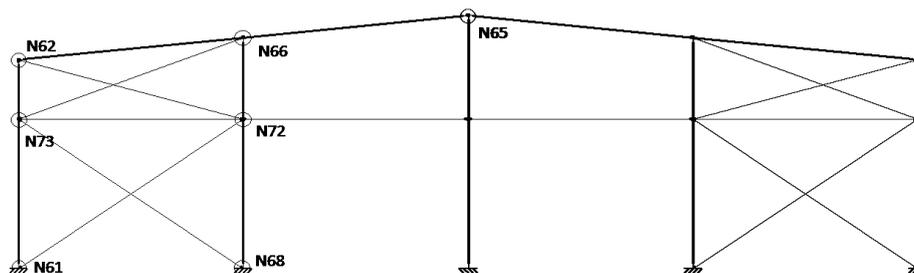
Vista del pórtico de fachada. (Fuente: Creación propia)
